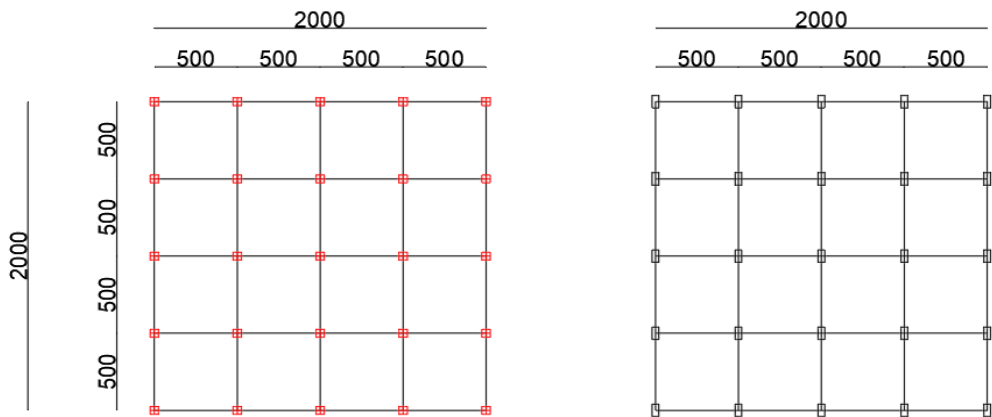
Örnek bina planı ve eksenlerin gösterimi
